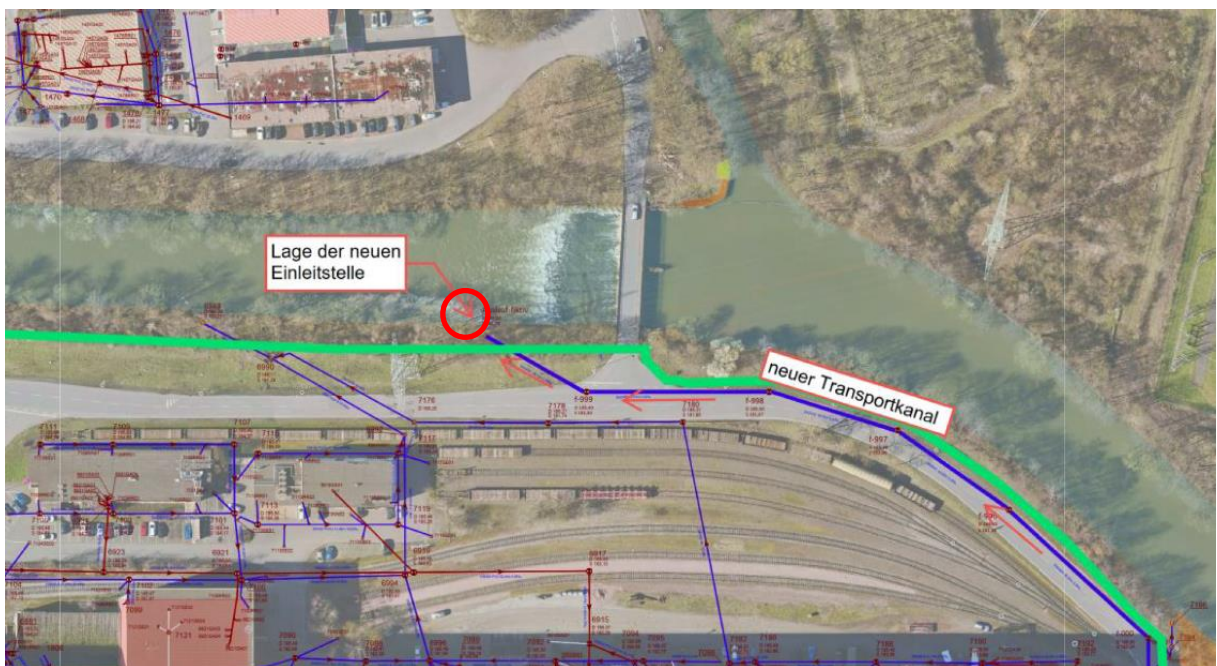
Lageplan Schweizer Ingenieure mit Lage der geplanten neuen Einleitstelle rot markiert [3]
